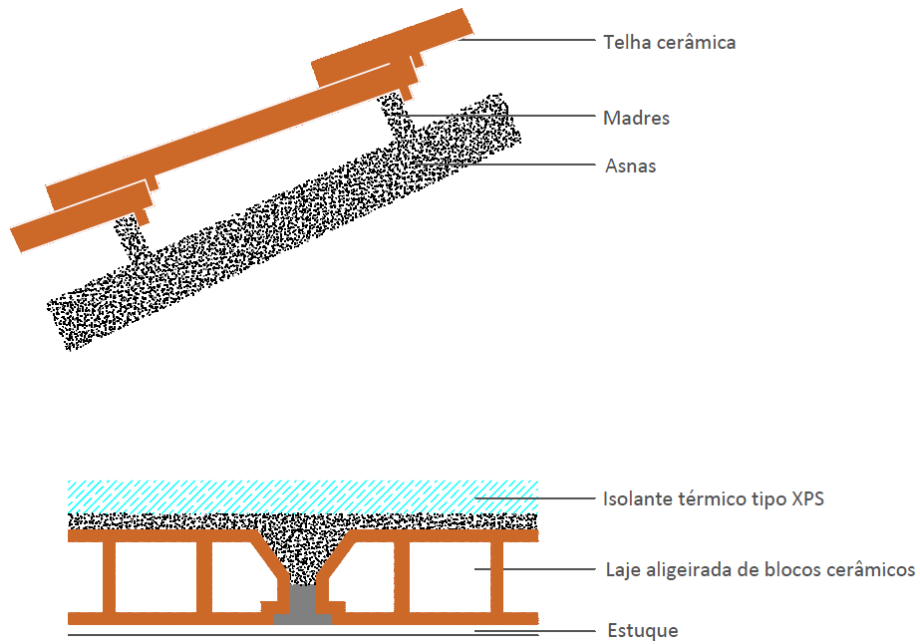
Solução construtiva tipo de pavimento para desvão sob cobertura – Pré intervenção
